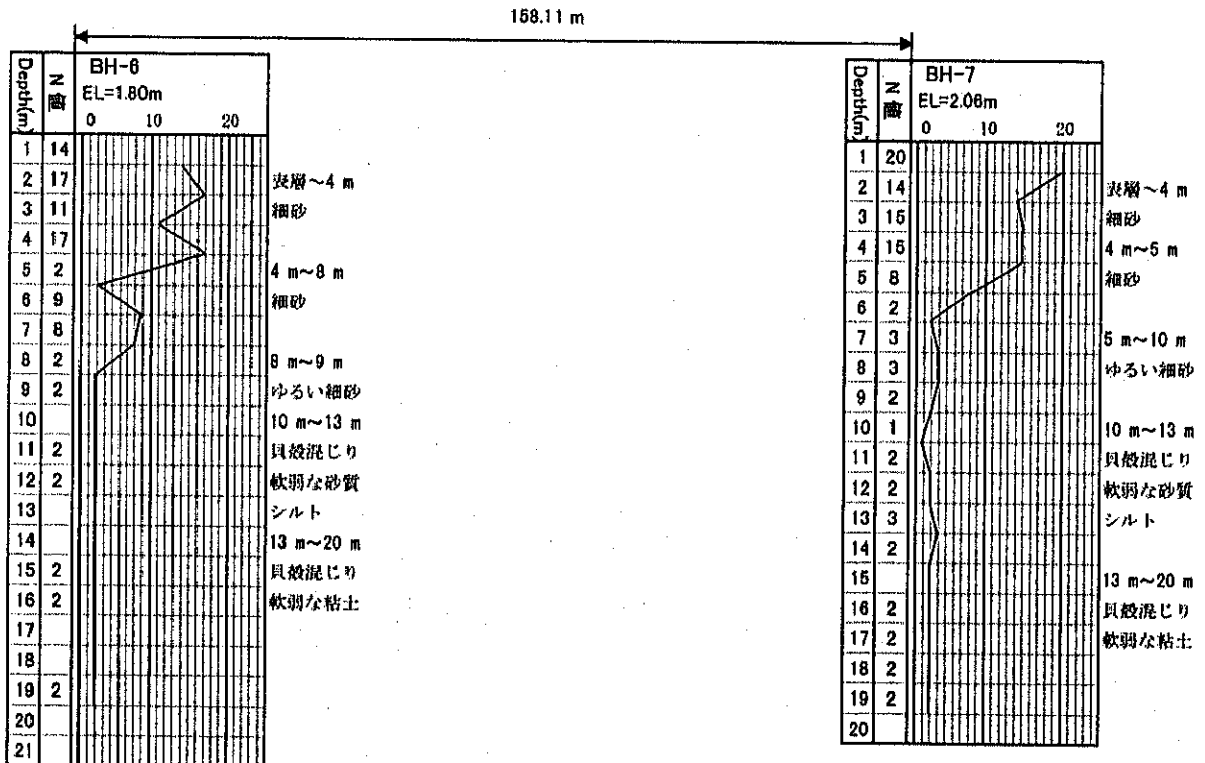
(4-3) 土質柱状図 (BH-6, BH-7)
